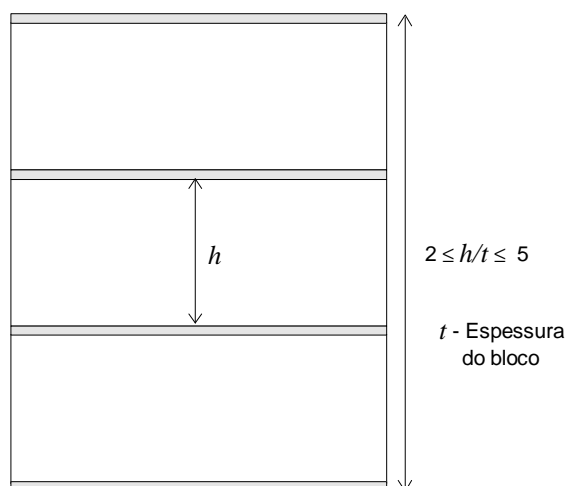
Provede para ensaio de alvenaria à compressão segundo ASTM E 447-84 “*stack bond*”
